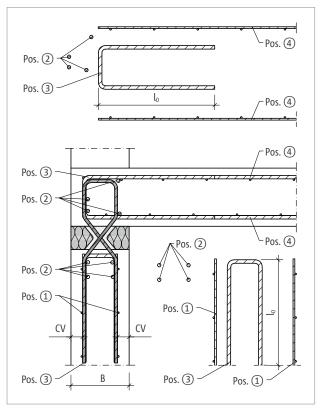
Schöck Sconnex® Typ W-N-VH: Variante B – bauseitige Bewehrung für Anschluss am Wandfuß
